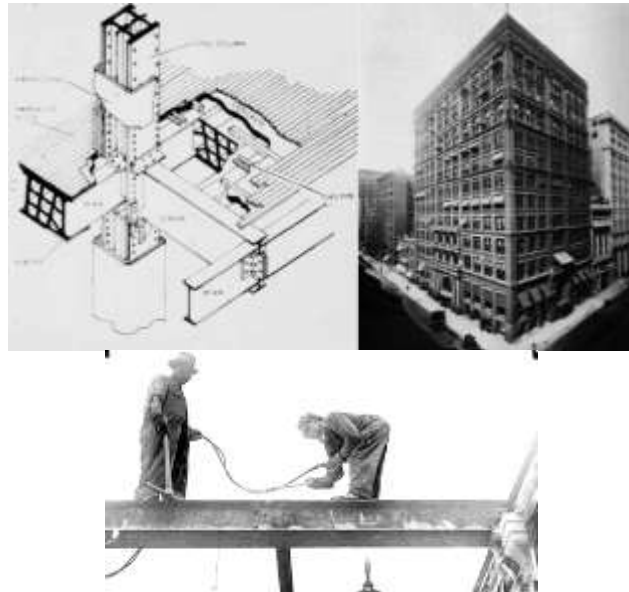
Detalles constructivos del Home Insurance Building de Chicago. Y escenas del montaje de la estructura de hierro. Tomado de www.chicagotribune.com recuperado el 15 de Marzo 2016
